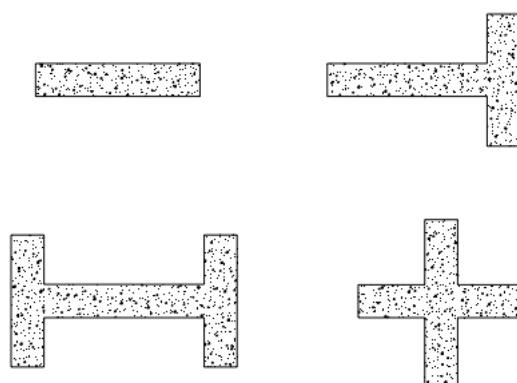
Exemplo de secções transversais de barretas (Brito, 2001).
